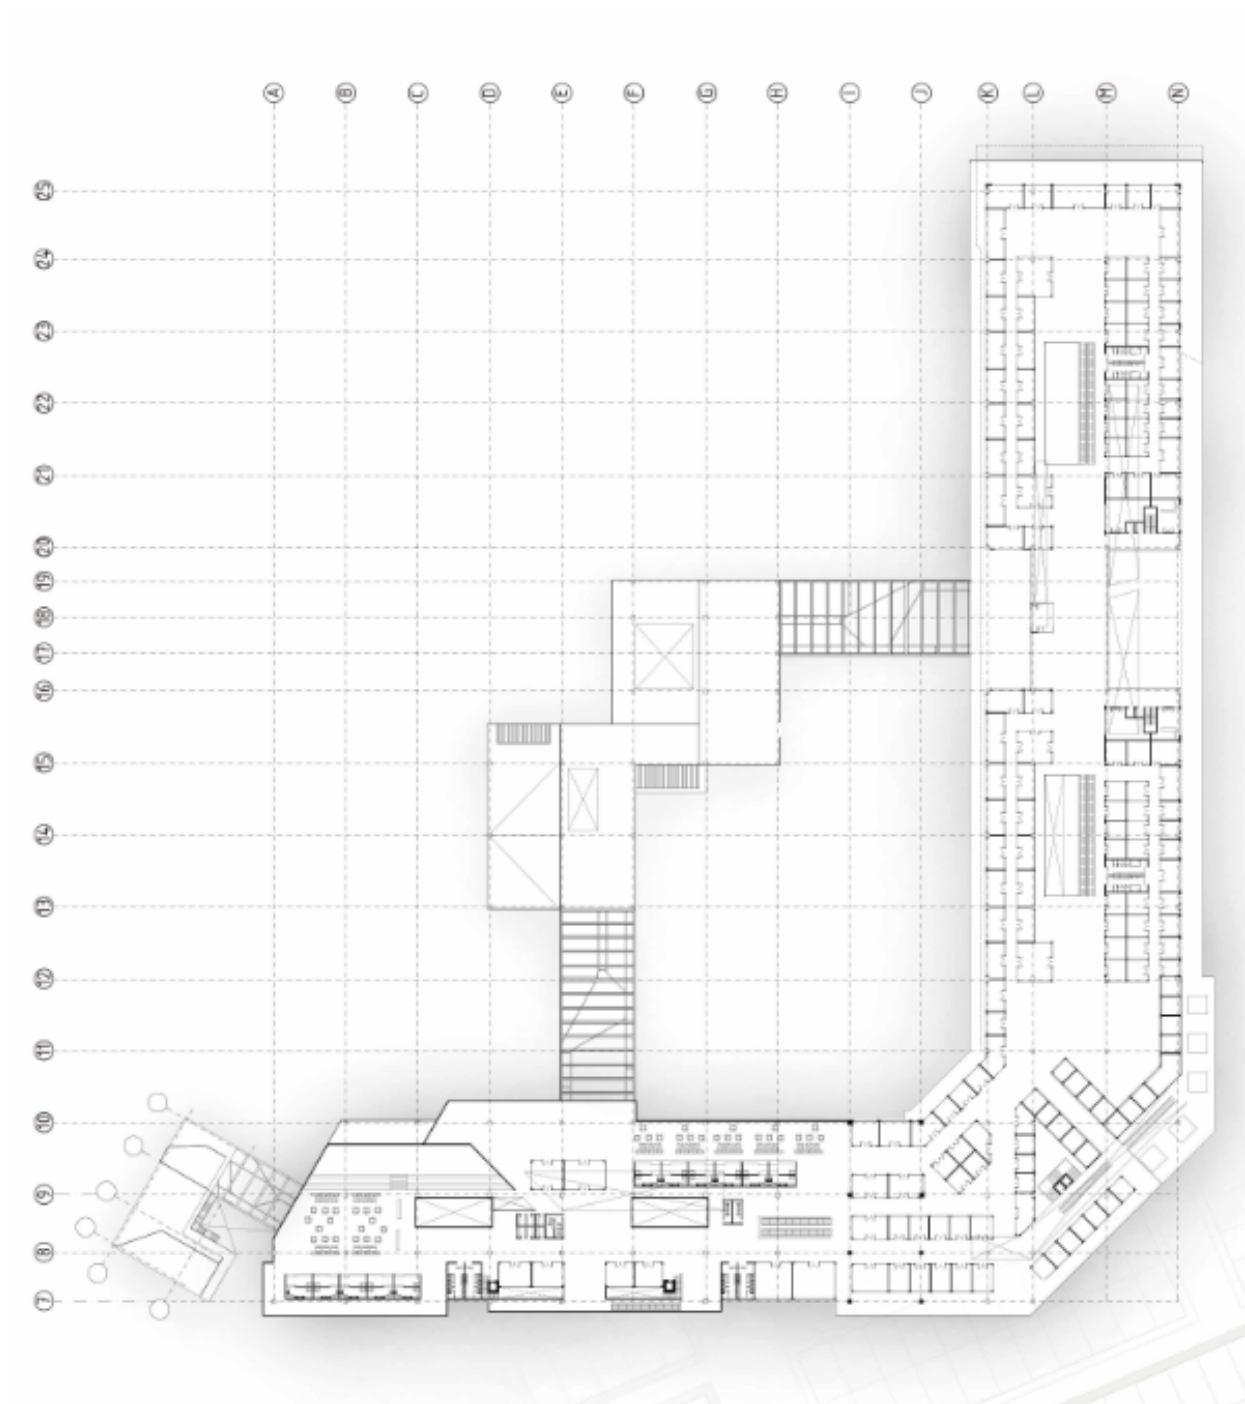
PLANTA ARQUITECTONICA SEGUNDO PISO ESC 1:1000
